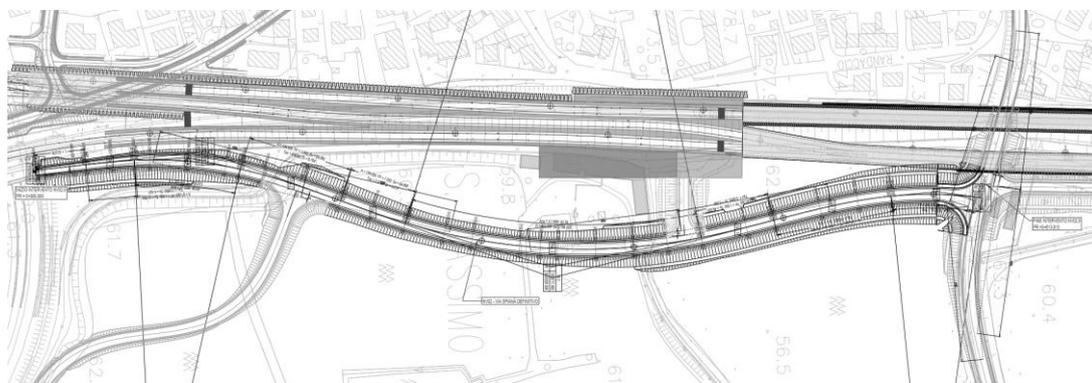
Stralcio planimetrico su rilievo Via della Spianà definitiva
